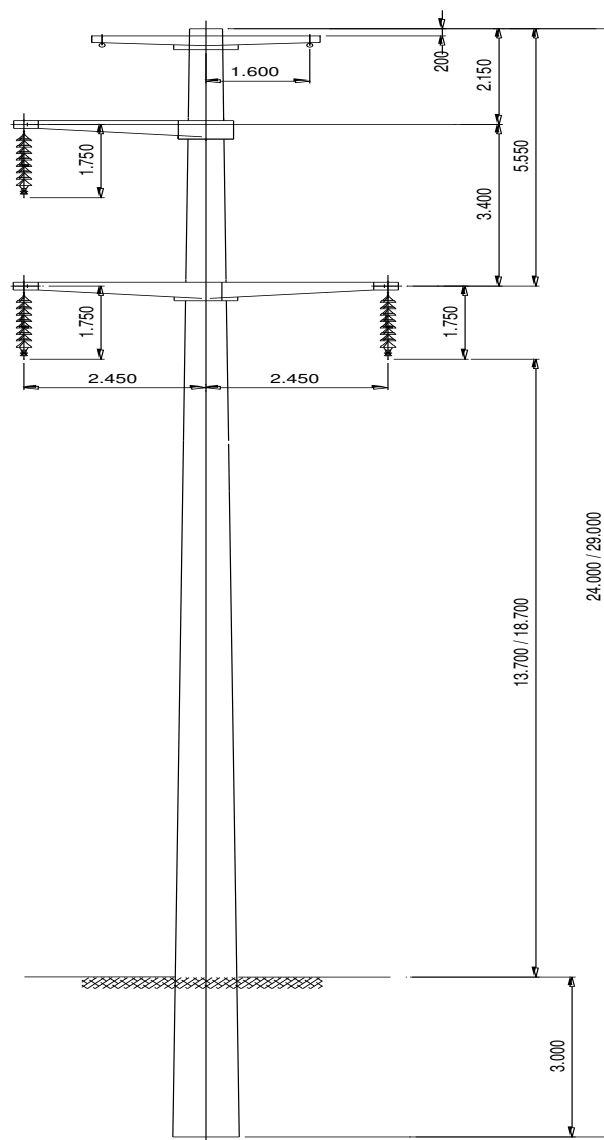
Tipo de Estrutura Suspensão (ASL1/BSL1).
